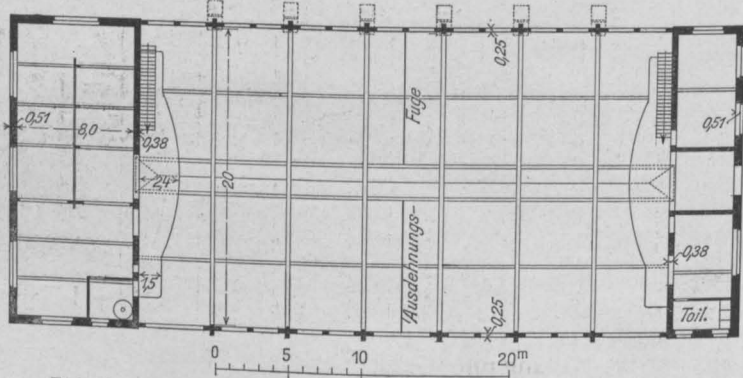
Grundriß der Montagehalle nebst Nebenräumen.
